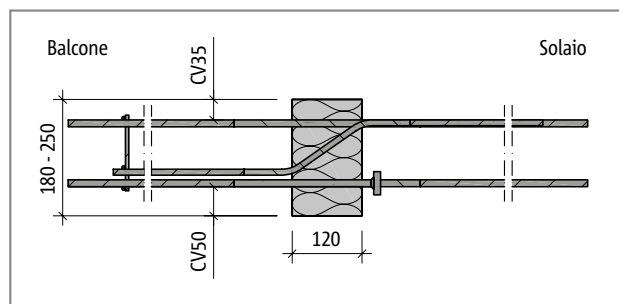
Schöck Isokorb® tipo EXT-L-CV35: sezione dell'elemento
